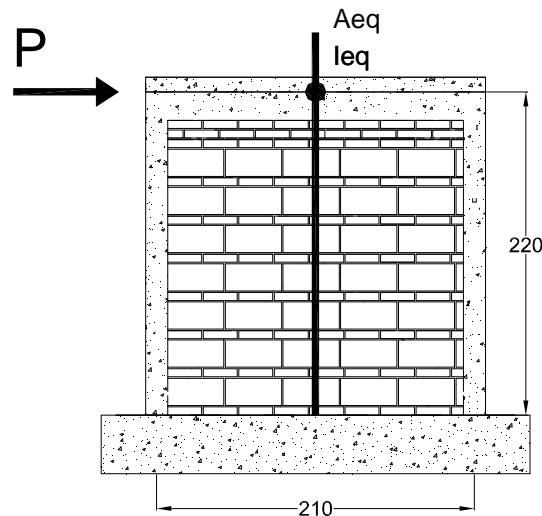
Modelado de muro MCC-4 como columna ancha.
